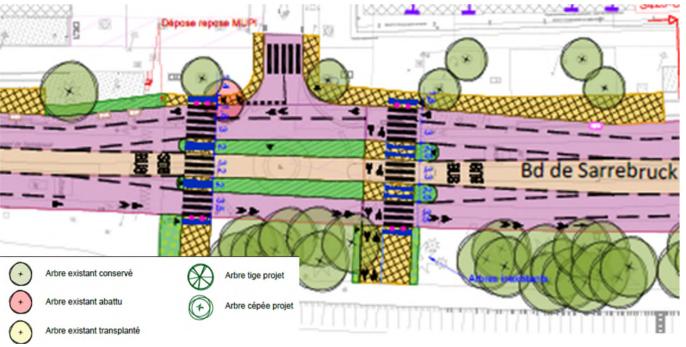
Bilan vert Sarrebruck - Doulon - Intersection rue de Hambourg - Valeur indicative
